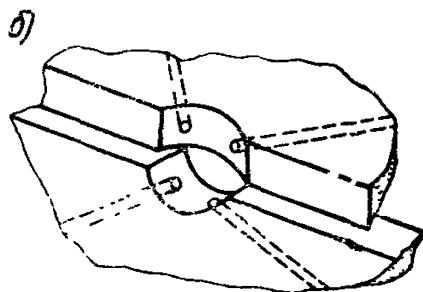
Пример выполнения электропроводки в каналах крупнопанельного жилого дома с монолитными железобетонными панелями (здание серии 1-464А):
